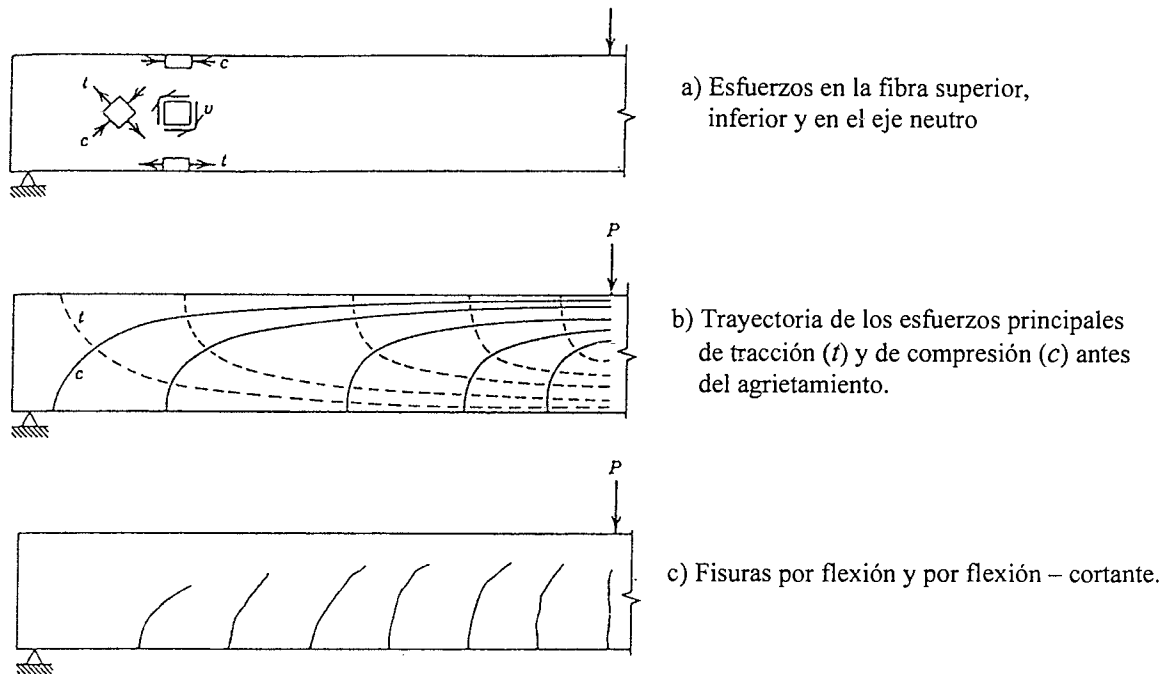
Esfuerzos principales y agrietamiento en una viga de concreto.
